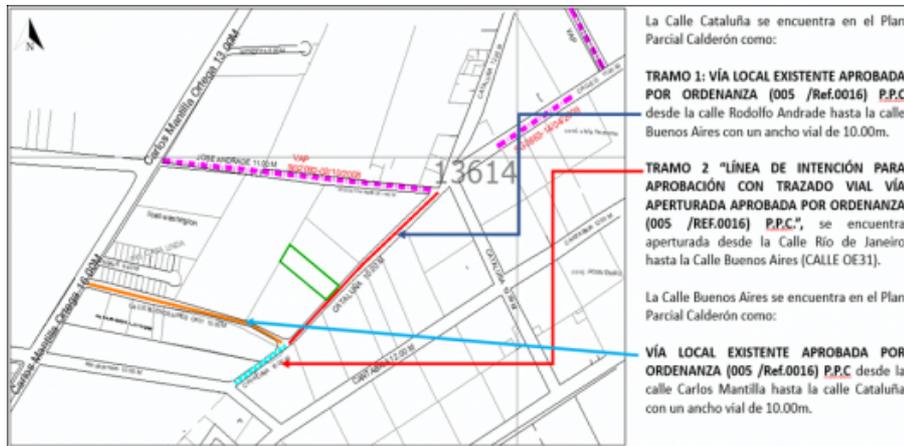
Plano vías a ser regularizadas. Fuente: Plan Parcial Calderón.
